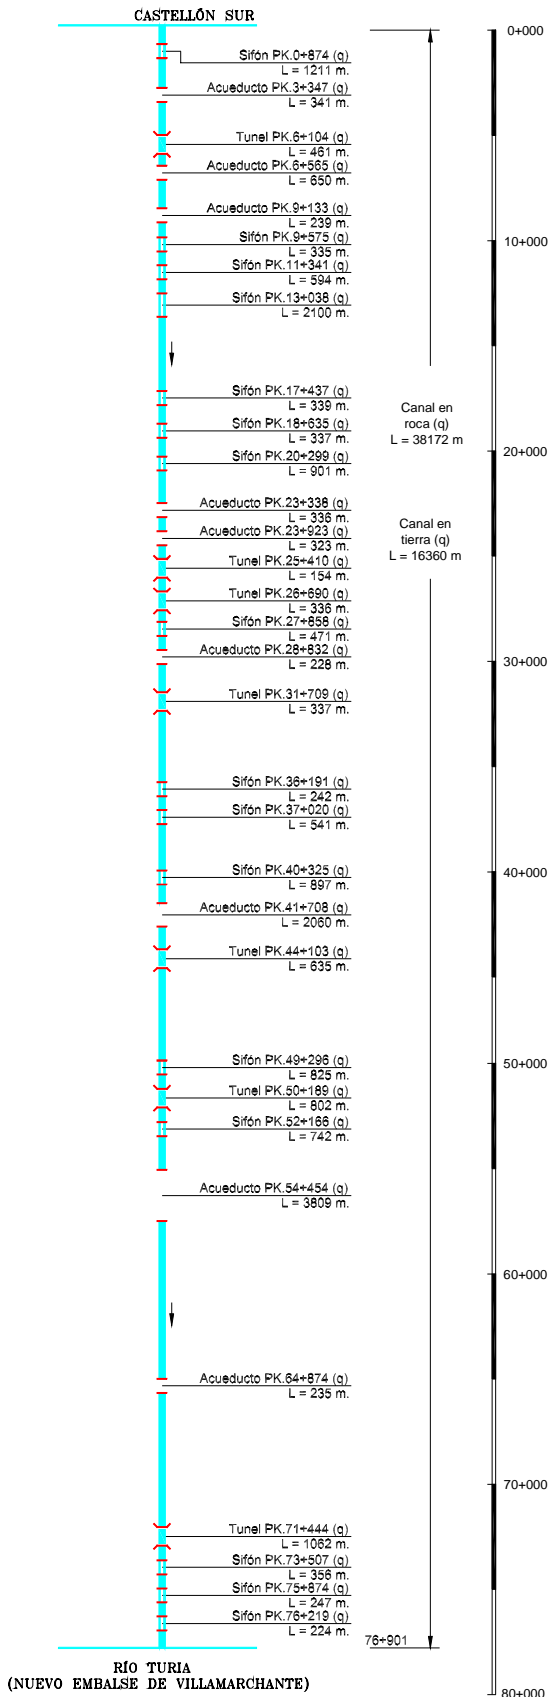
Conducción Castellón Sur - Turia. Esquema en planta
